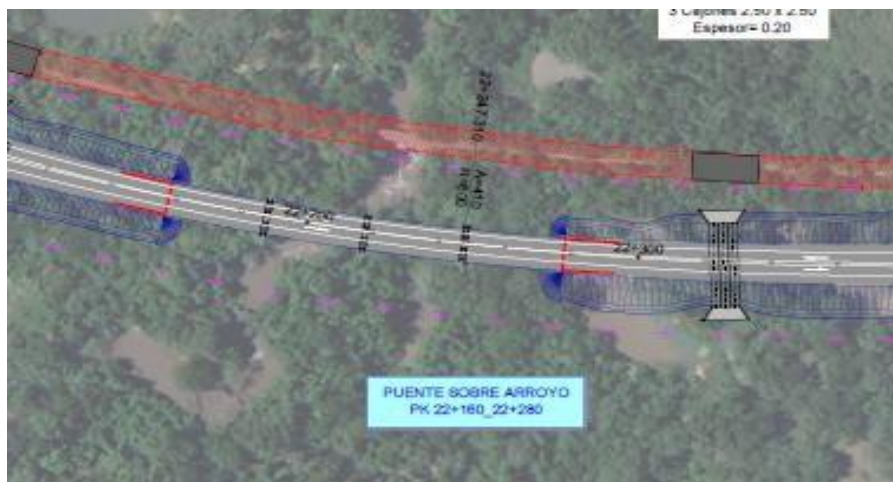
Puente sobre arroyo Yukyry. PK 22+160 al 22+280
